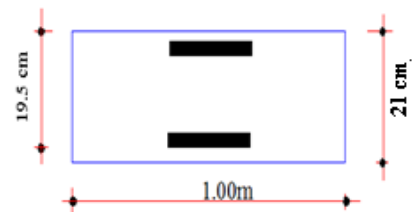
Dimension de la dalle pleine en appui Y-Y
